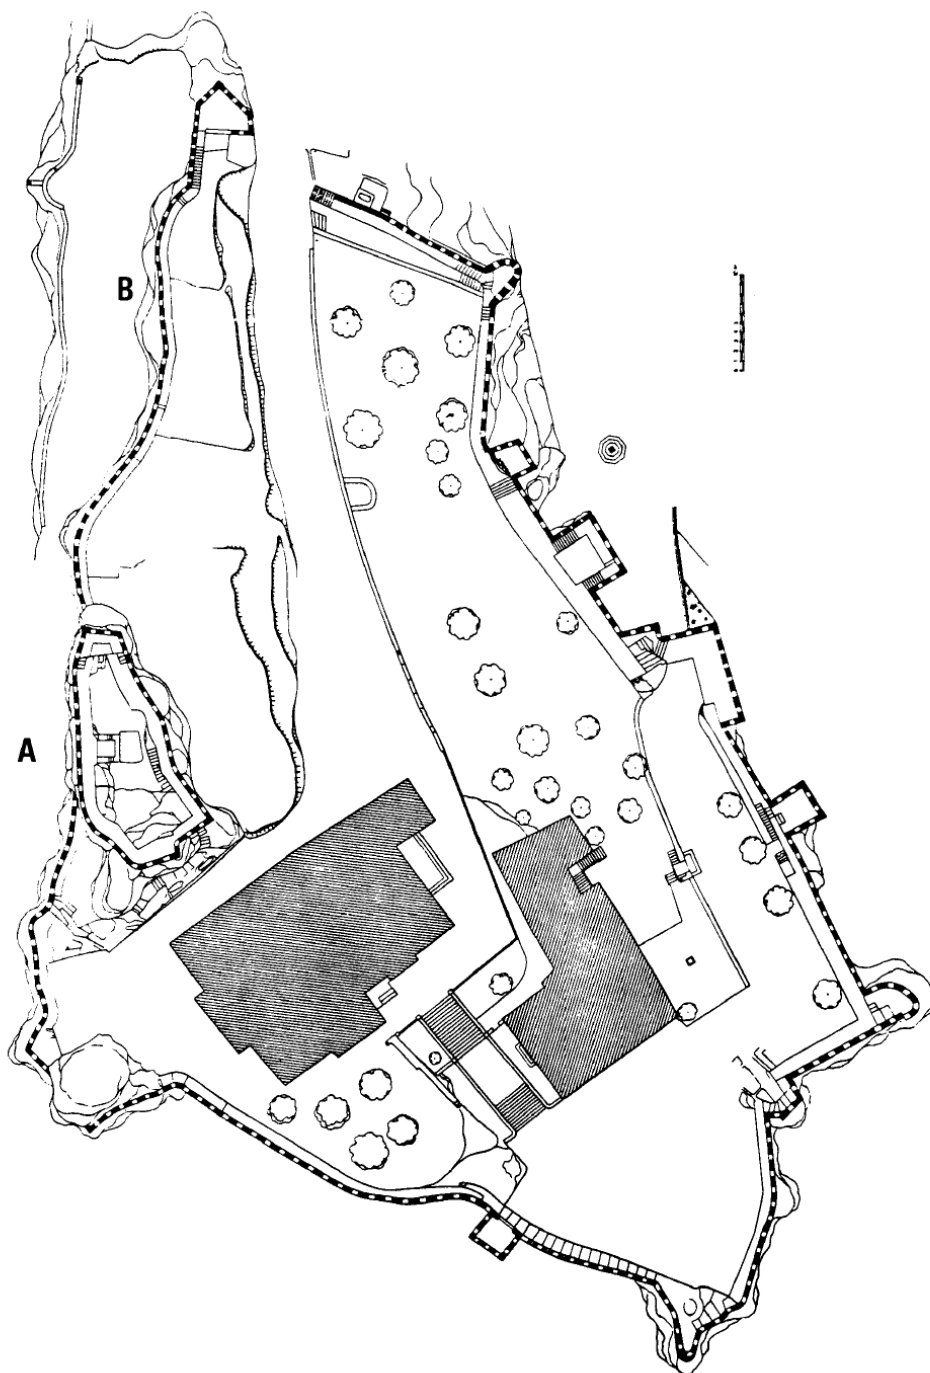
Castelo de Penela — Planta da D.G.E.M.N.
